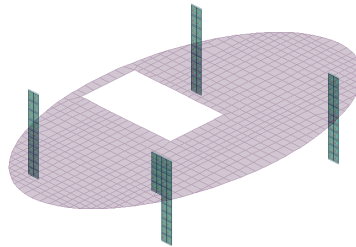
Esquema pilares. Fuente: elaboración propia.
